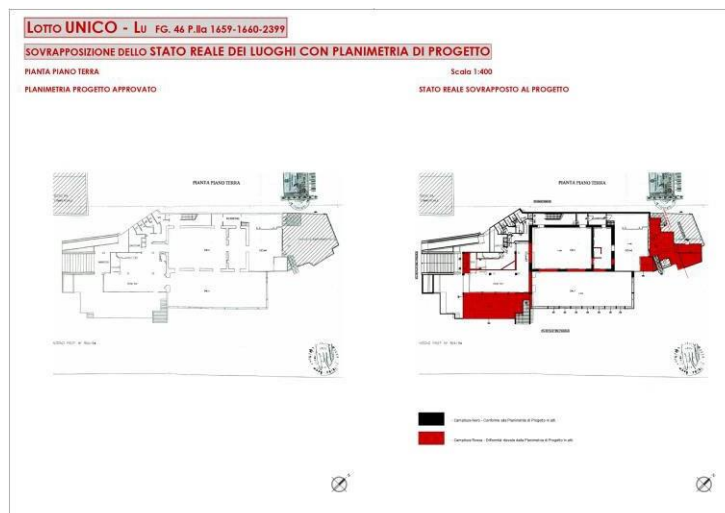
Raffronto stato reale con planimetria di Progetto LOTTO LU – P. T. (ALL. 08).
